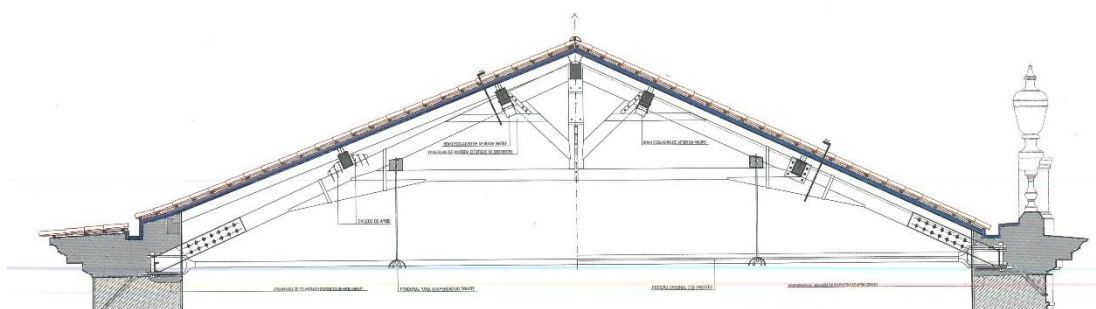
Pormenor Construtivo da Estrutura de Madeira do Laboratório Químico de Coimbra
